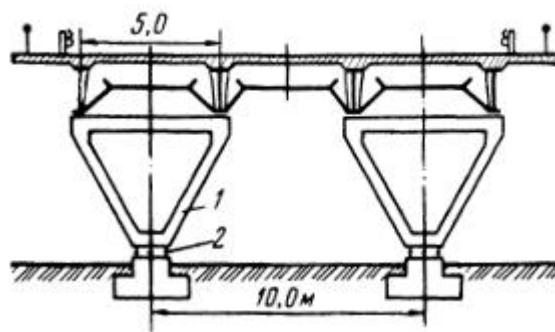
Металева рамна опора: 1 – рама; 2 – шарнірно-нерухома опорна частина
